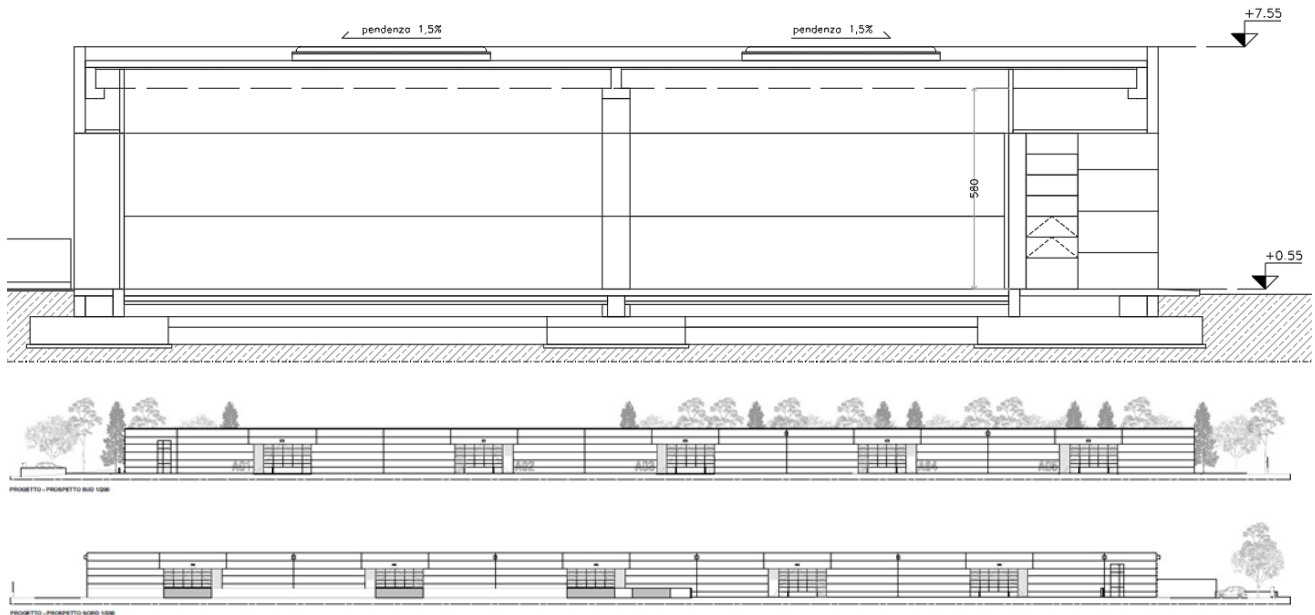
Estratto – progetto sezione tipo e prospetti longitudinali sud e nord
